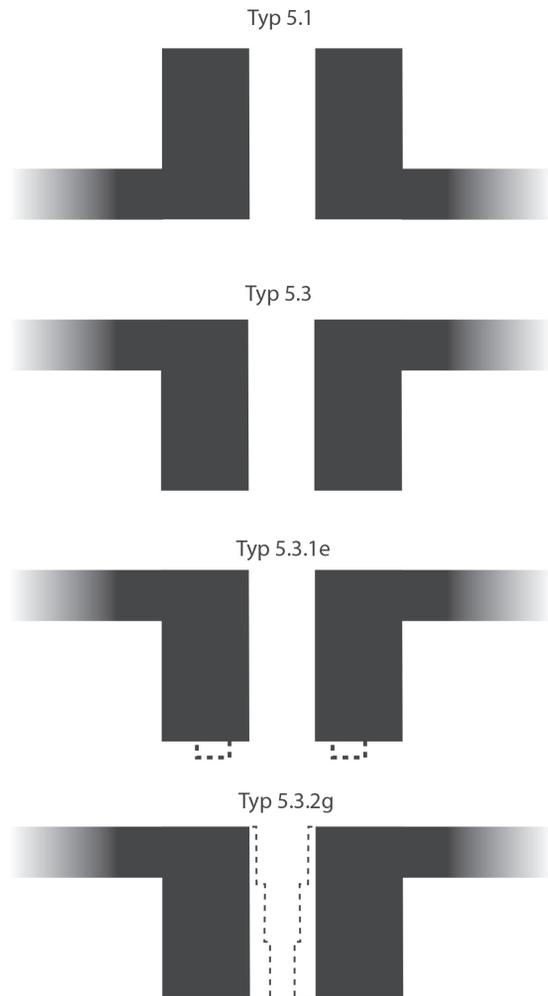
Auswahl möglicher Torgrundrisse des Typs 5
